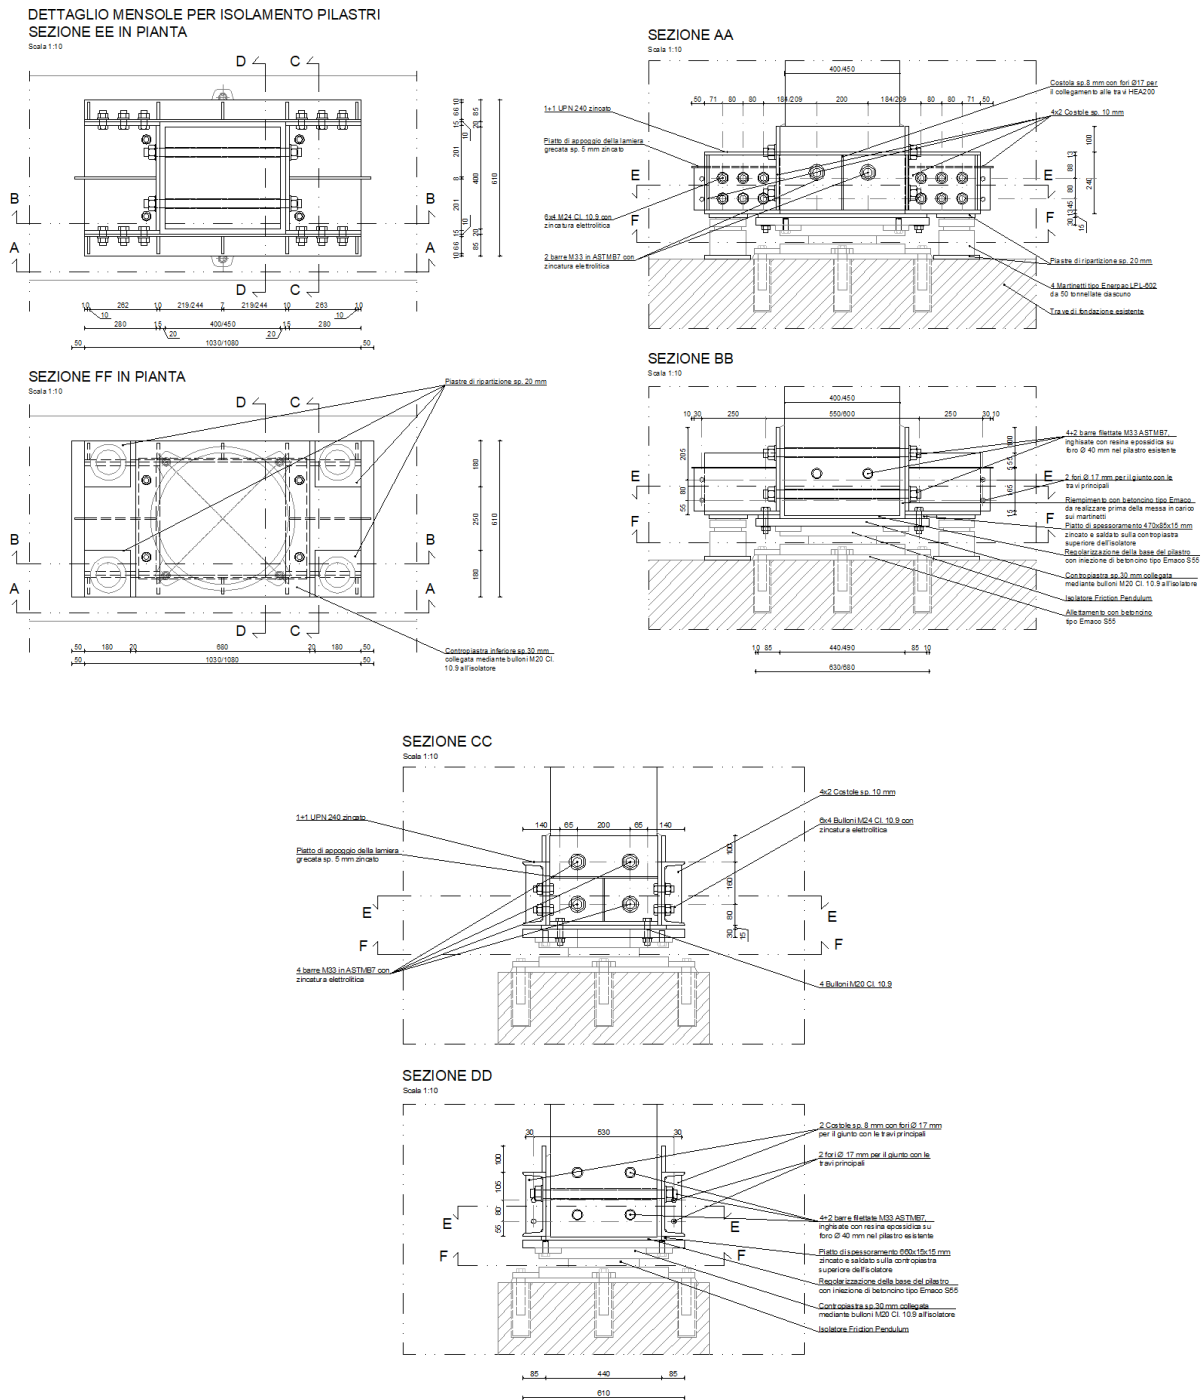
Dettaglio delle mensole di sollevamento dei pilastri per l'installazione degli isolatori.
